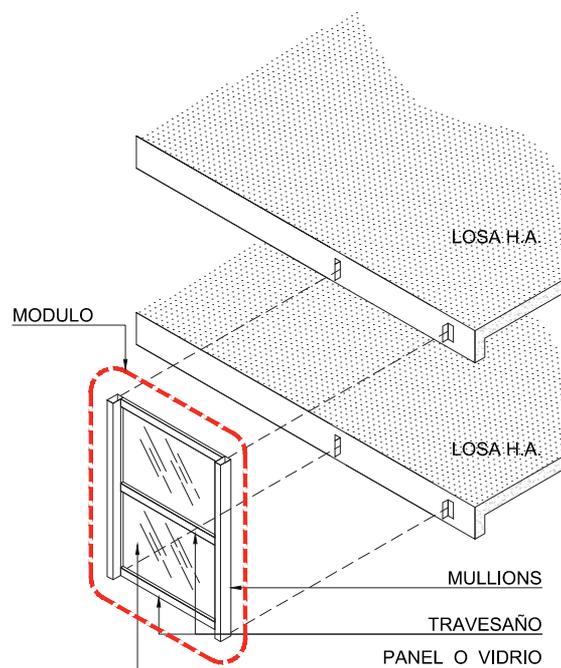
Sistema de Muro Cortina Tipo Frame.
